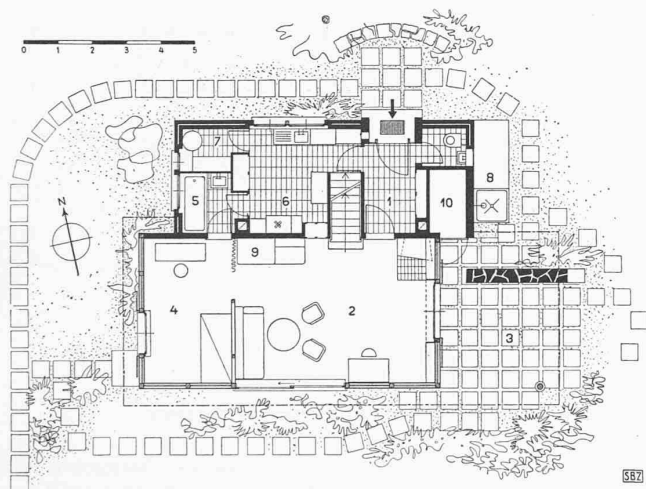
Grundriss des Hauptgeschosses, 1:200. Legende im Text
